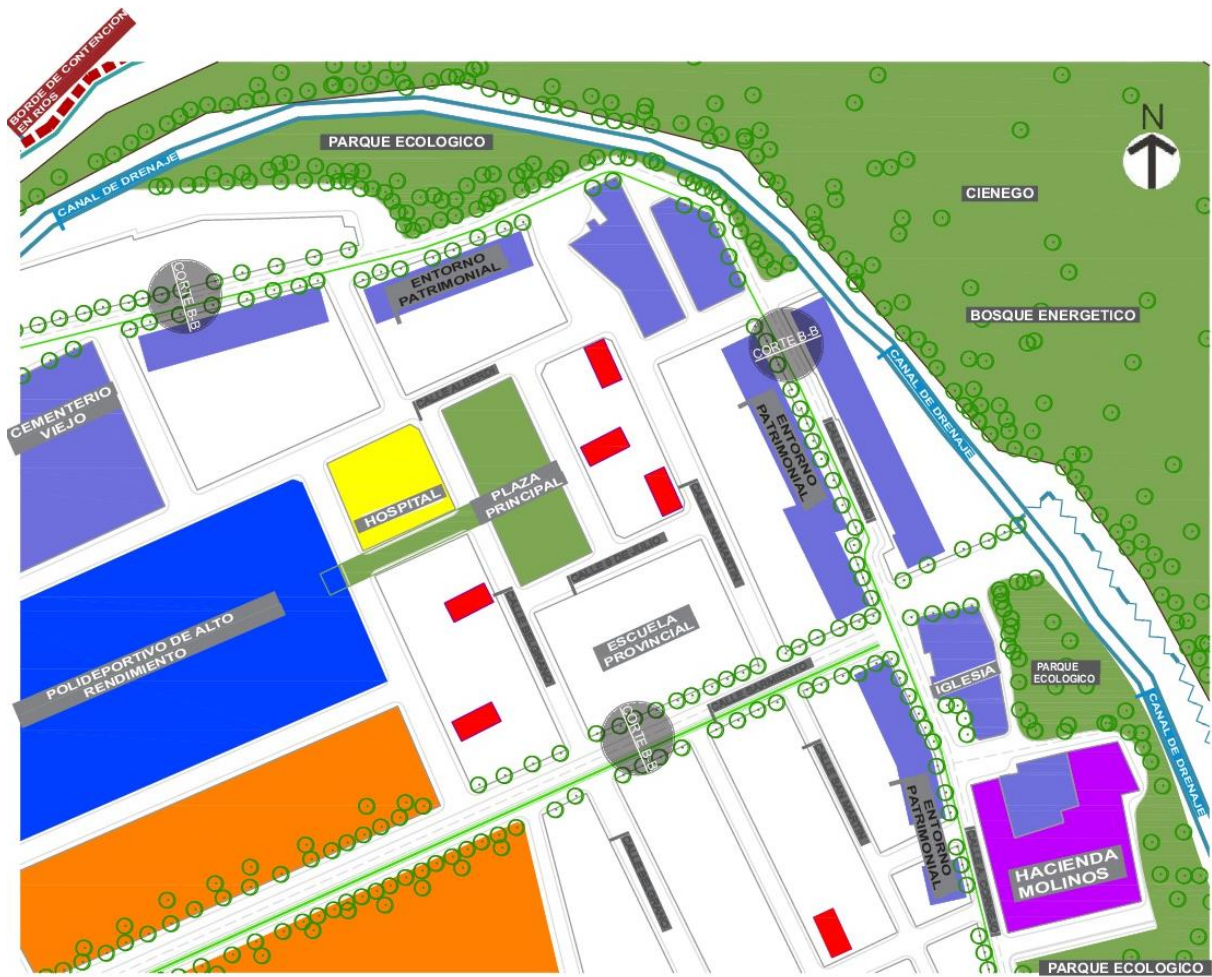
Planta y corte esquemático de la propuesta de parque ecológico en Calle Abraham Cornejo y canal de drenaje (ver Fig. 98)
